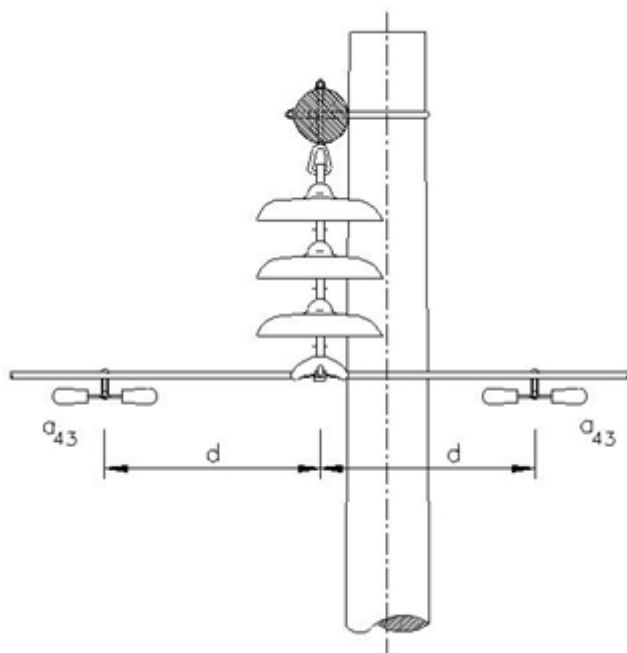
Instalación de amortiguador tipo Stock bridge
